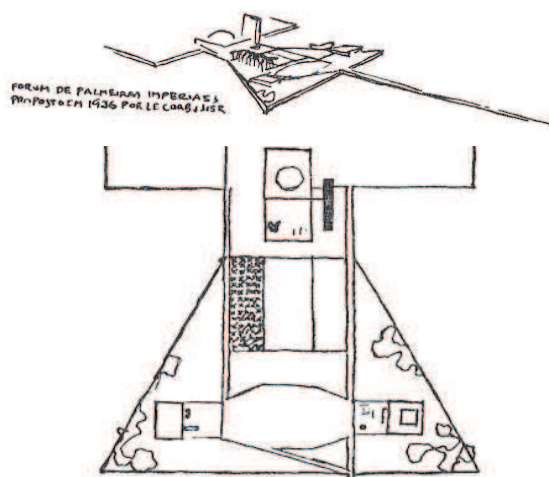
Perspectiva e planta da Praça dos Três Poderes (croquis do Plano Piloto de Brasília - 1957). Fonte: Costa (1991).
